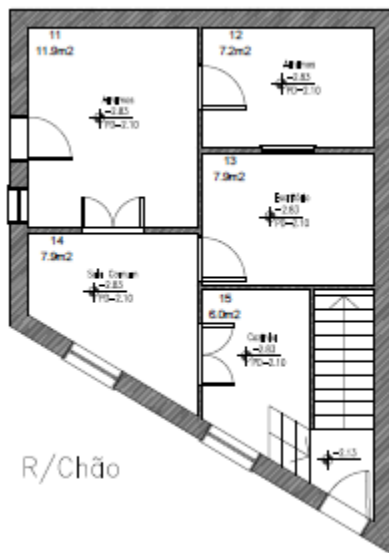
Planta Atual do R/Chão (Não existe no projeto de 1916)
